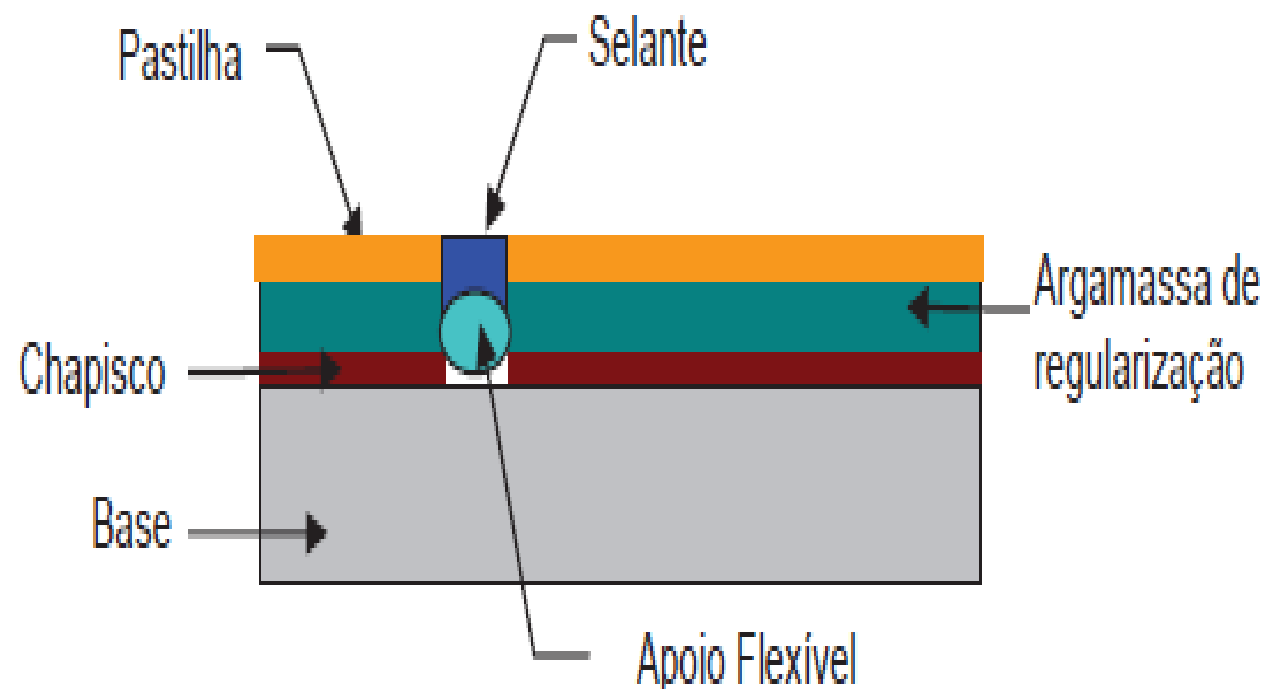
Detalhe genérico – Junta de movimentação VERTICAL.
